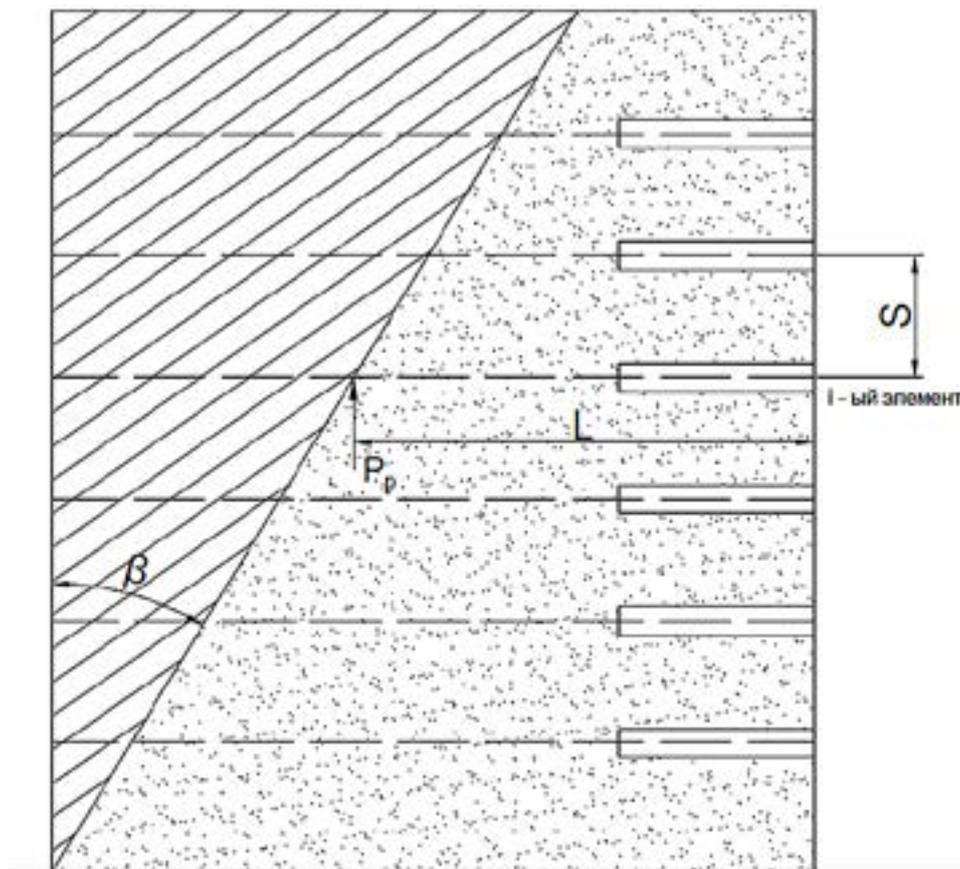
Схема к расчету потери внутренней устойчивости из-за разрыва армирующего элемента
